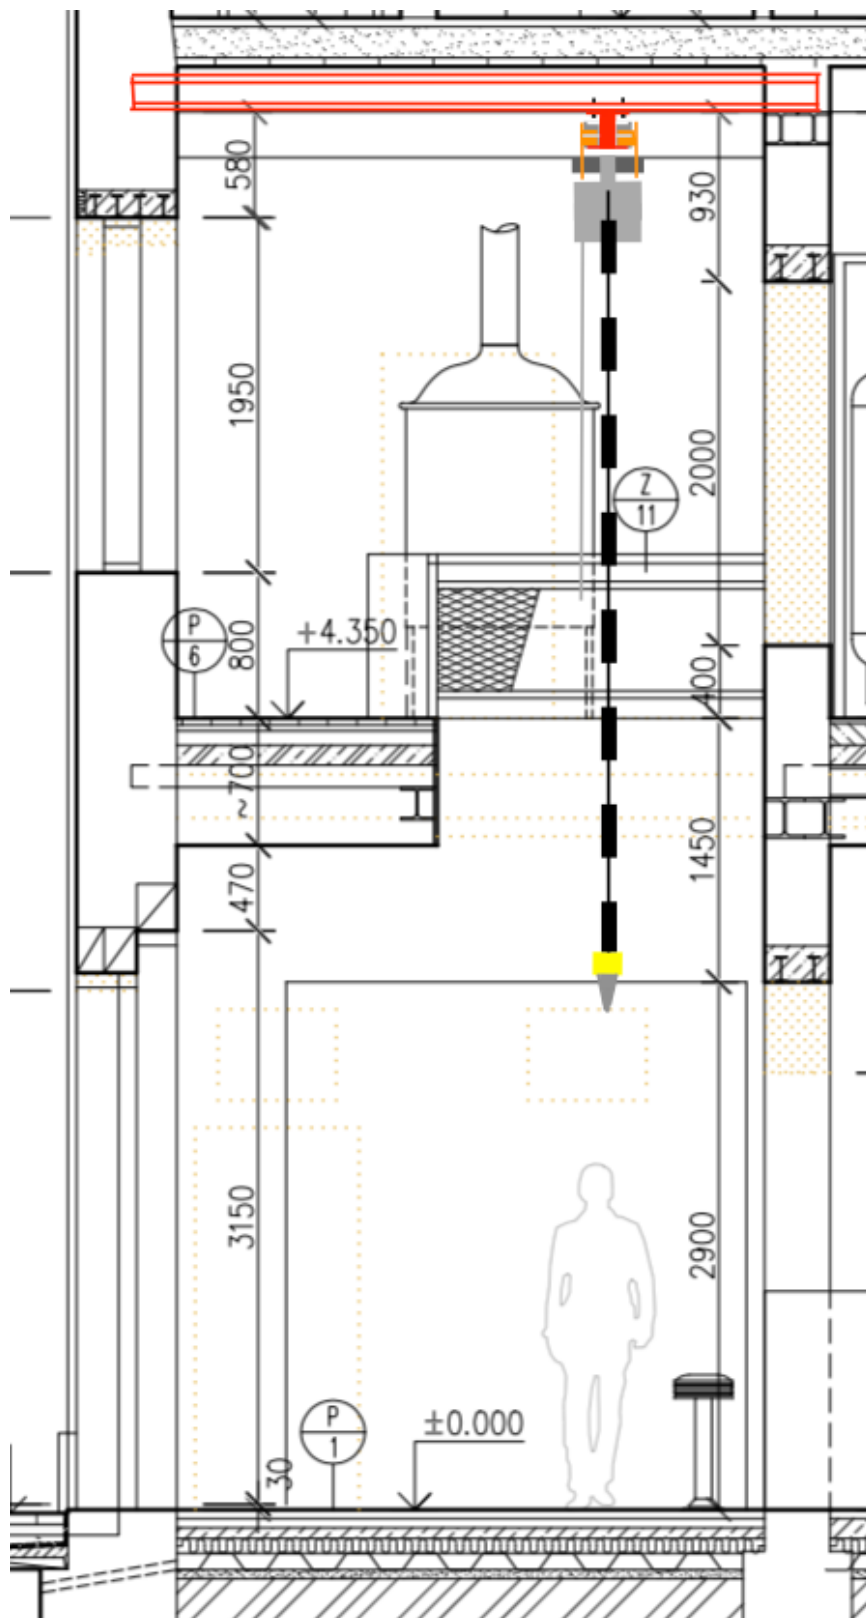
Půdorys; Umístění návrhu A do budovy [Autor]
